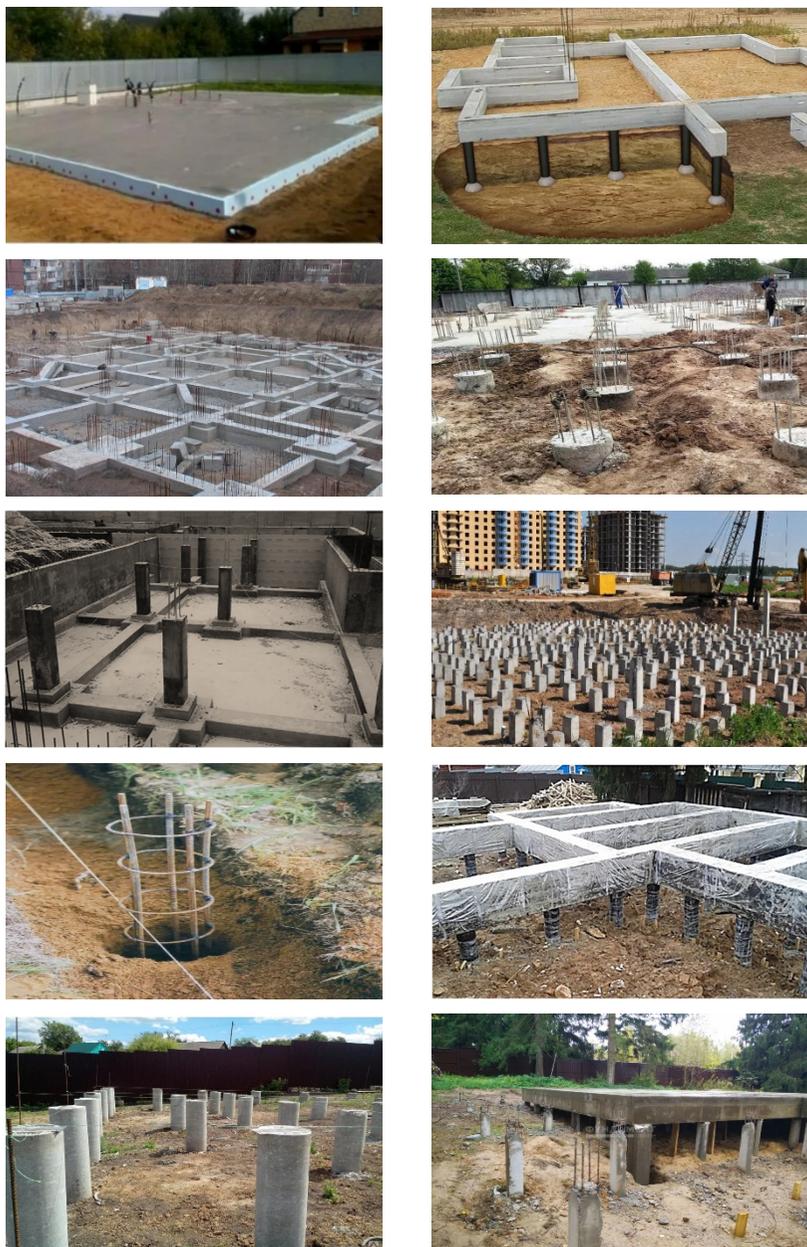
Примеры сплошных и свайных фундаментов
